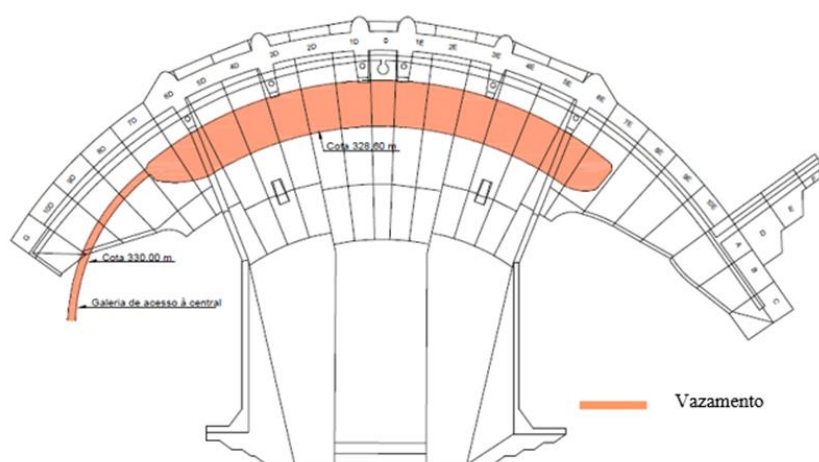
Planta da barragem da Bemposta (vazamento representado a laranja) (adaptado de LNEC, 2020).
